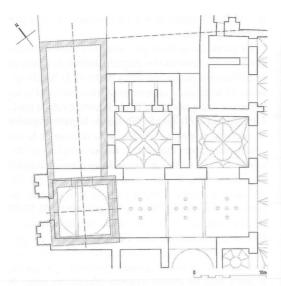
Propuesta de planta de la iglesia primigenia (dibujo de los autores)
